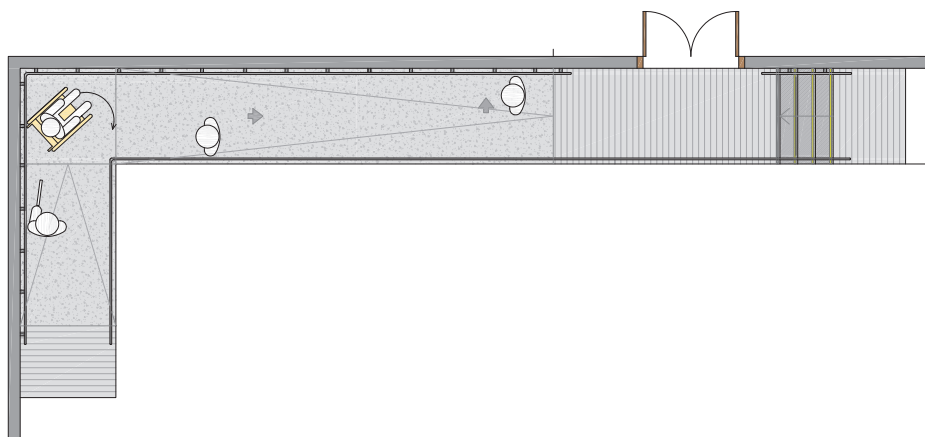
Planta de una rampa en esquina y detalle de encuentro con escalera y puerta de acceso a otra dependencia.
